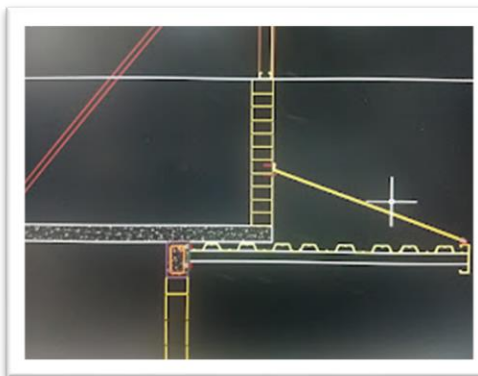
Propuesta de techado perimetral a base de lámina acanalada y estructura metálica. Autoría propia (2020)
